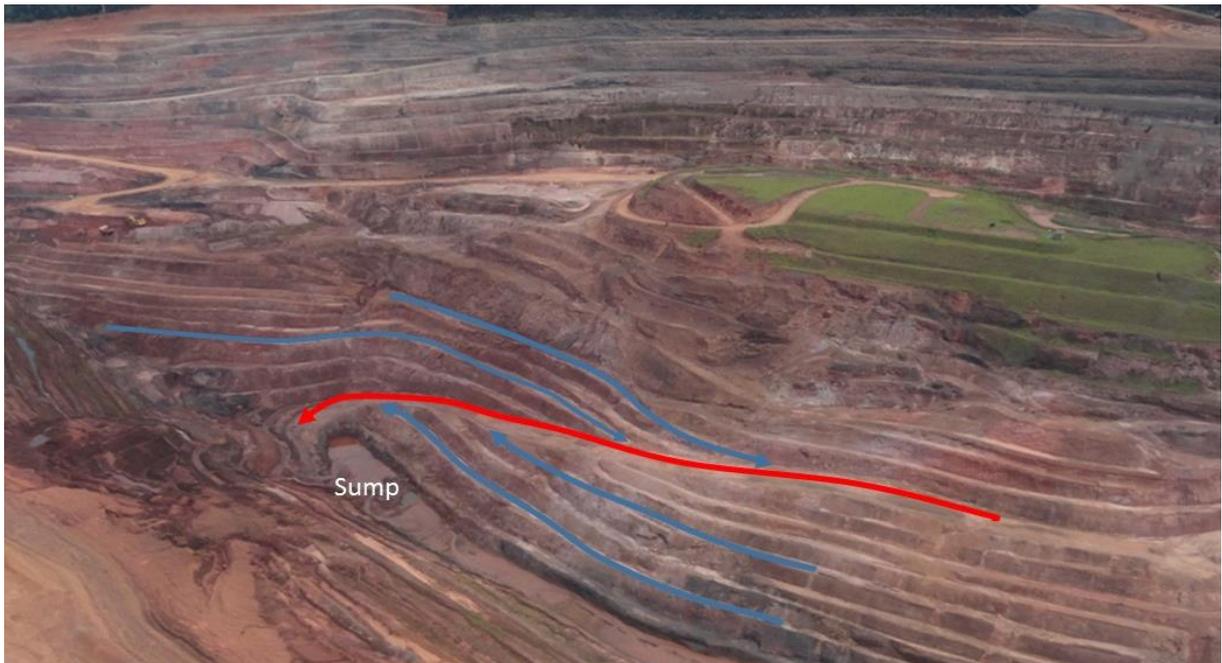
Esquema de drenagem de mina – canaletas de banco (azul) e de acesso (vermelho) - Mina do Manganês do Azul – 2017
